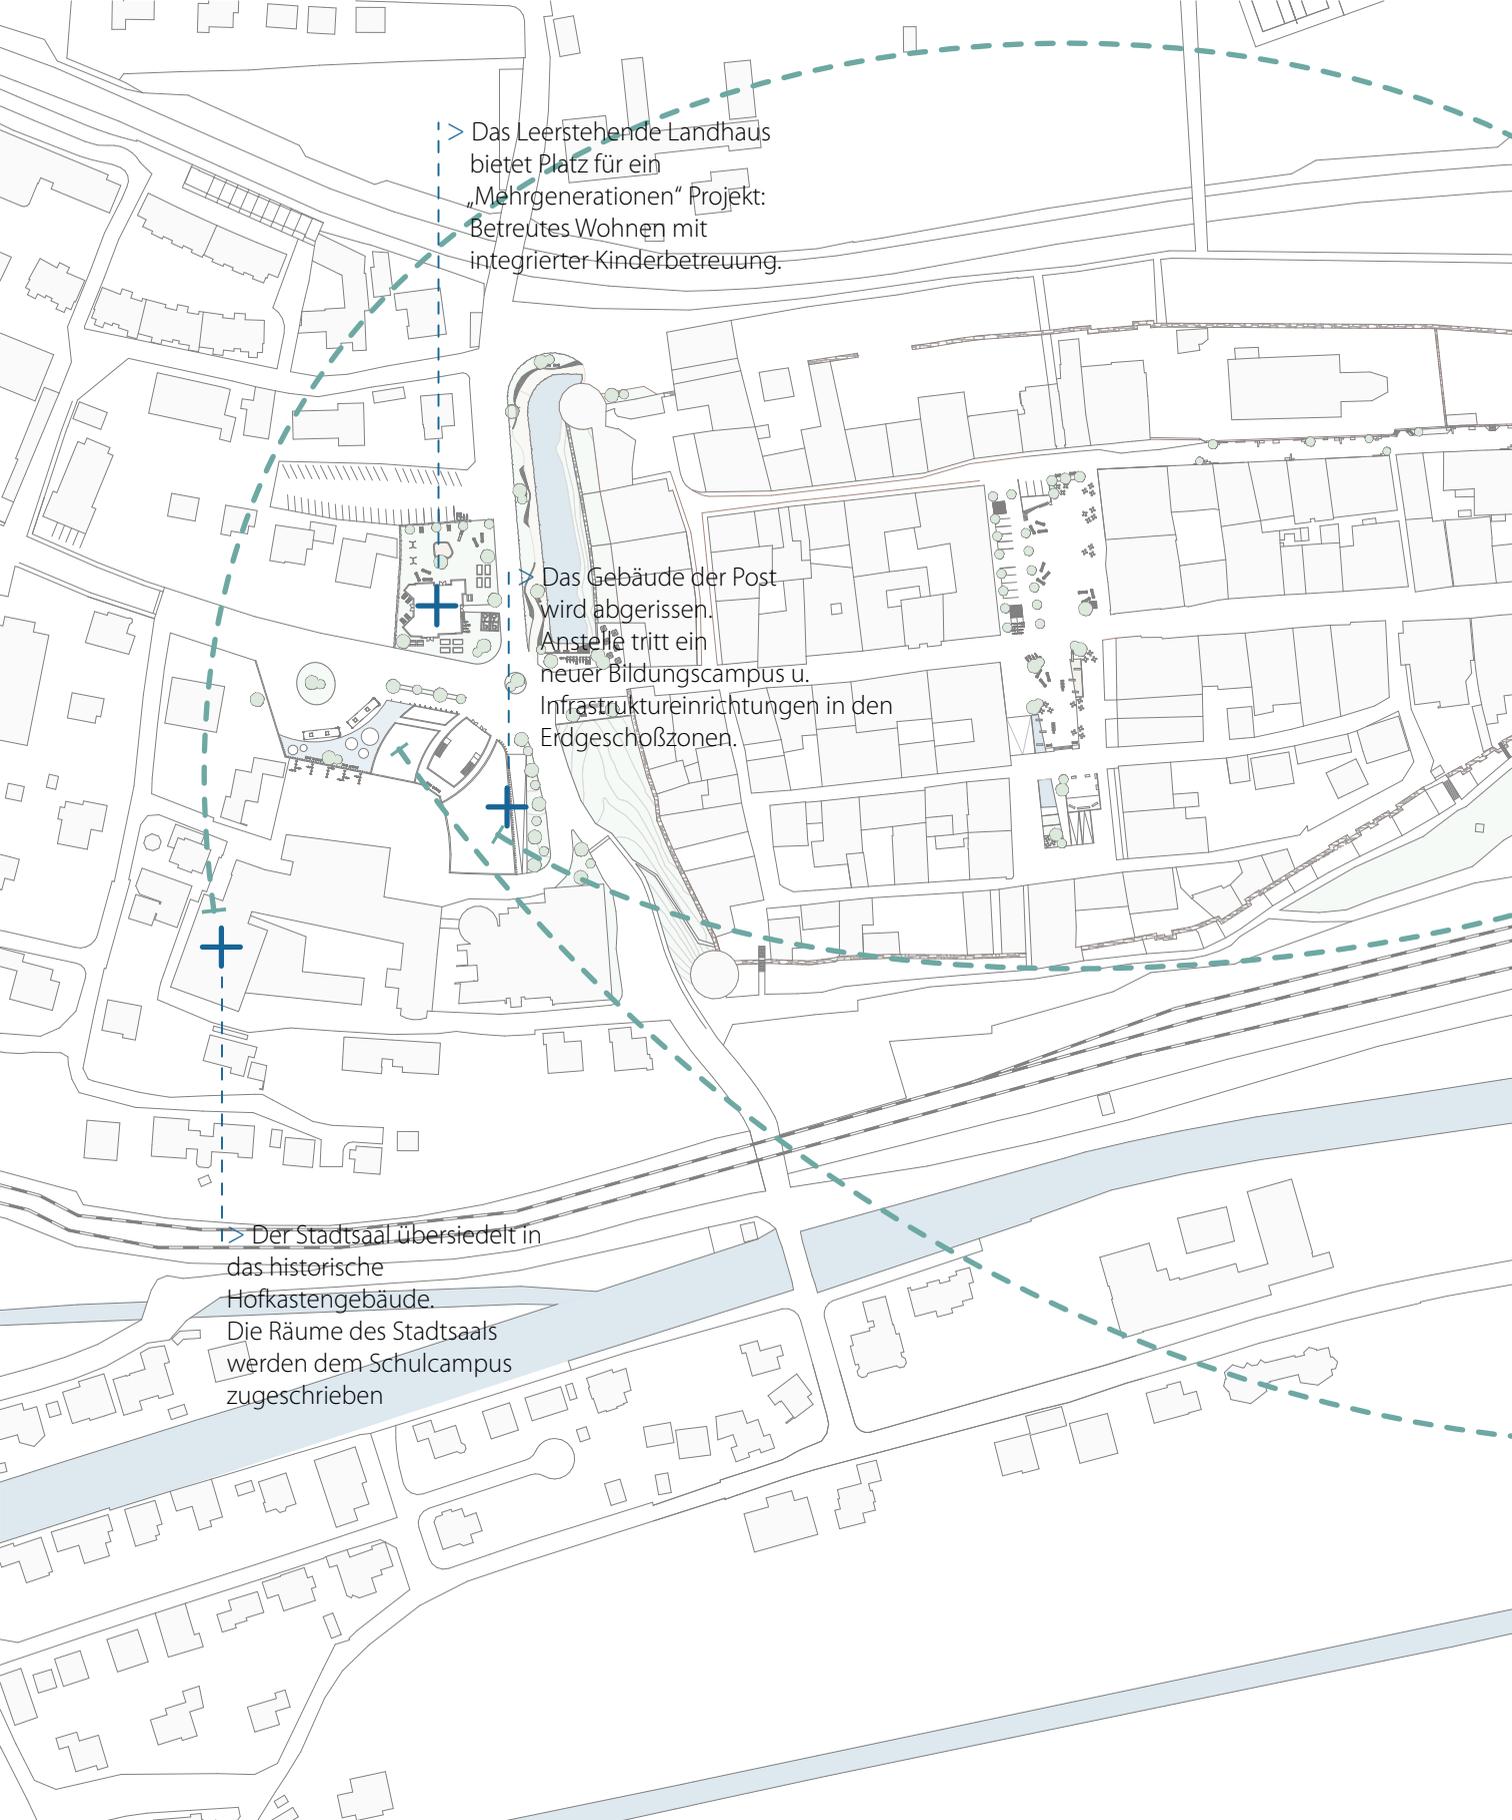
| Grundriss Verkehrsraum M 1:5000
